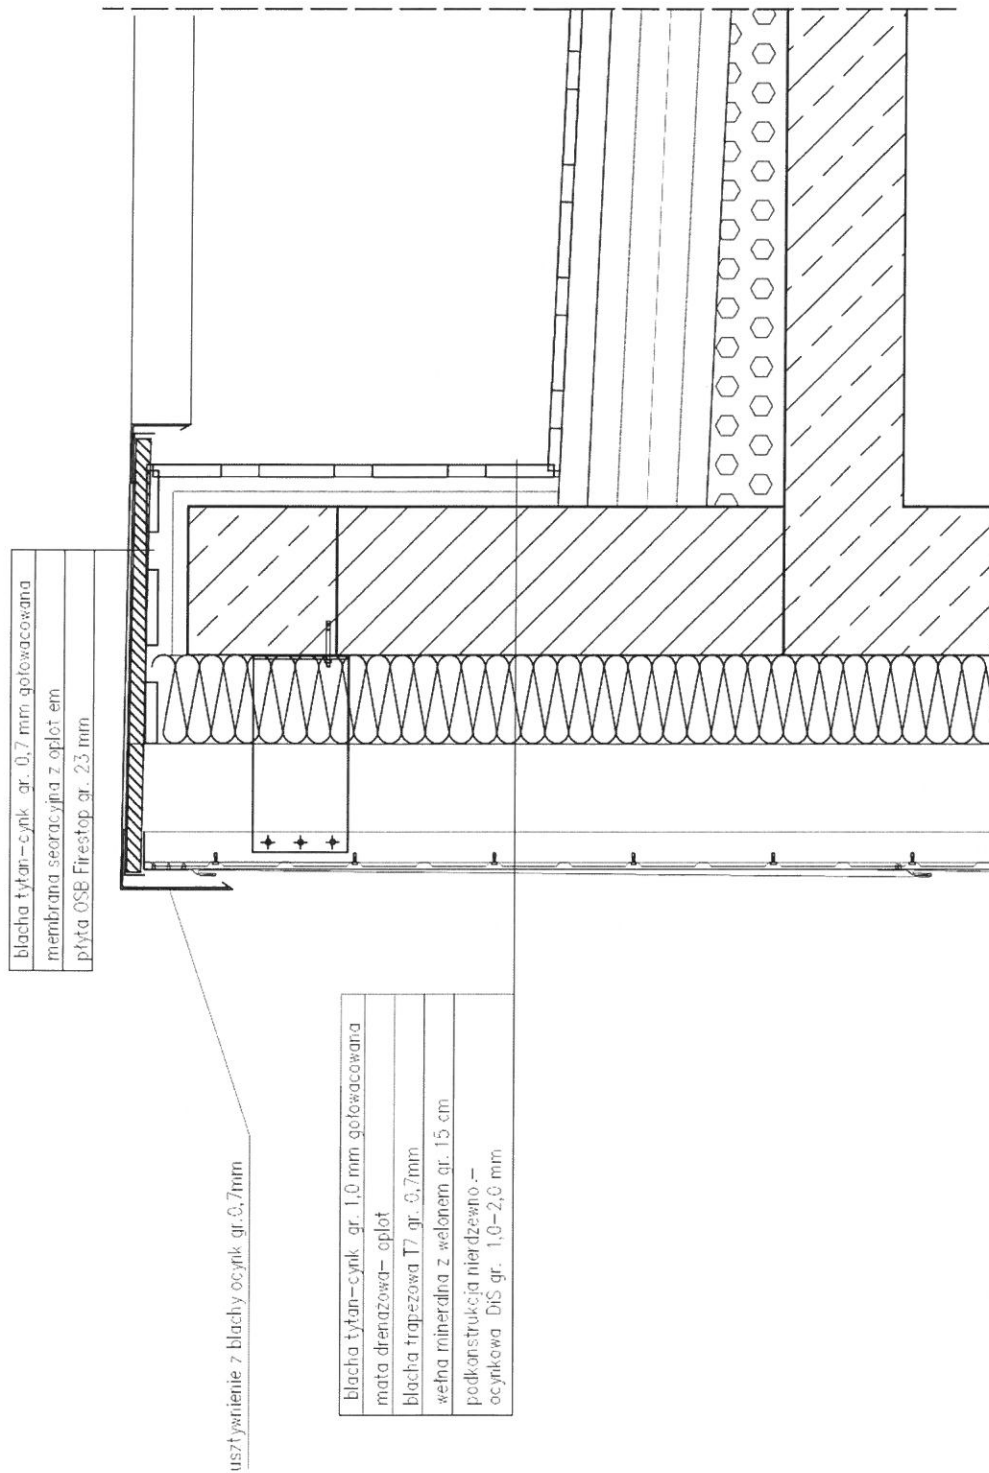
Przekrój pionowy typowego rozwiązania elewacji.
